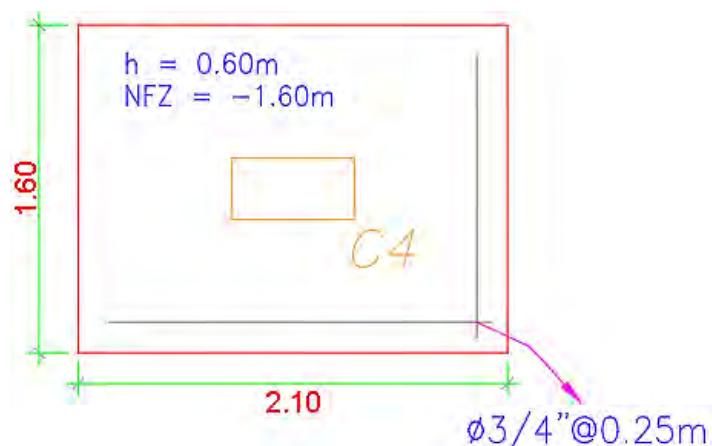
Diseño final de zapata para la columna C4 (eje D-3)
